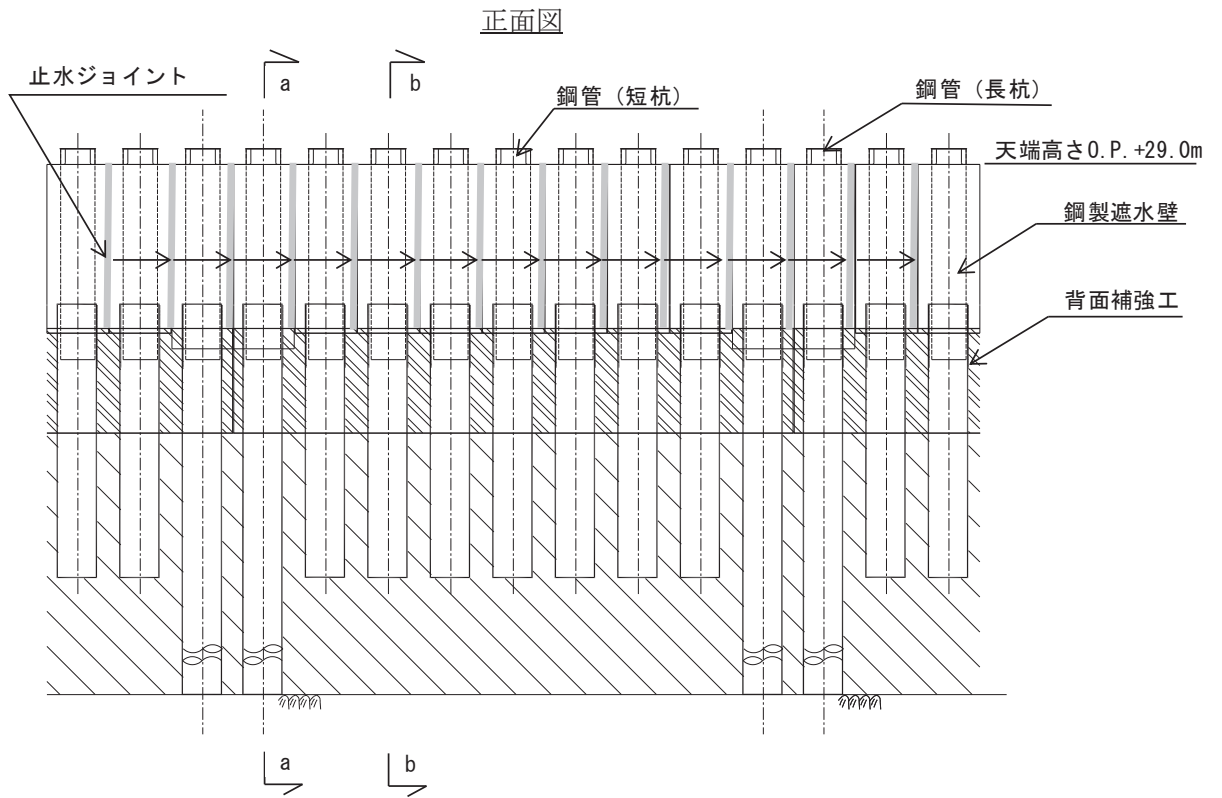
(2) 一般部の構造図 (正面図, 鋼製遮水壁)
